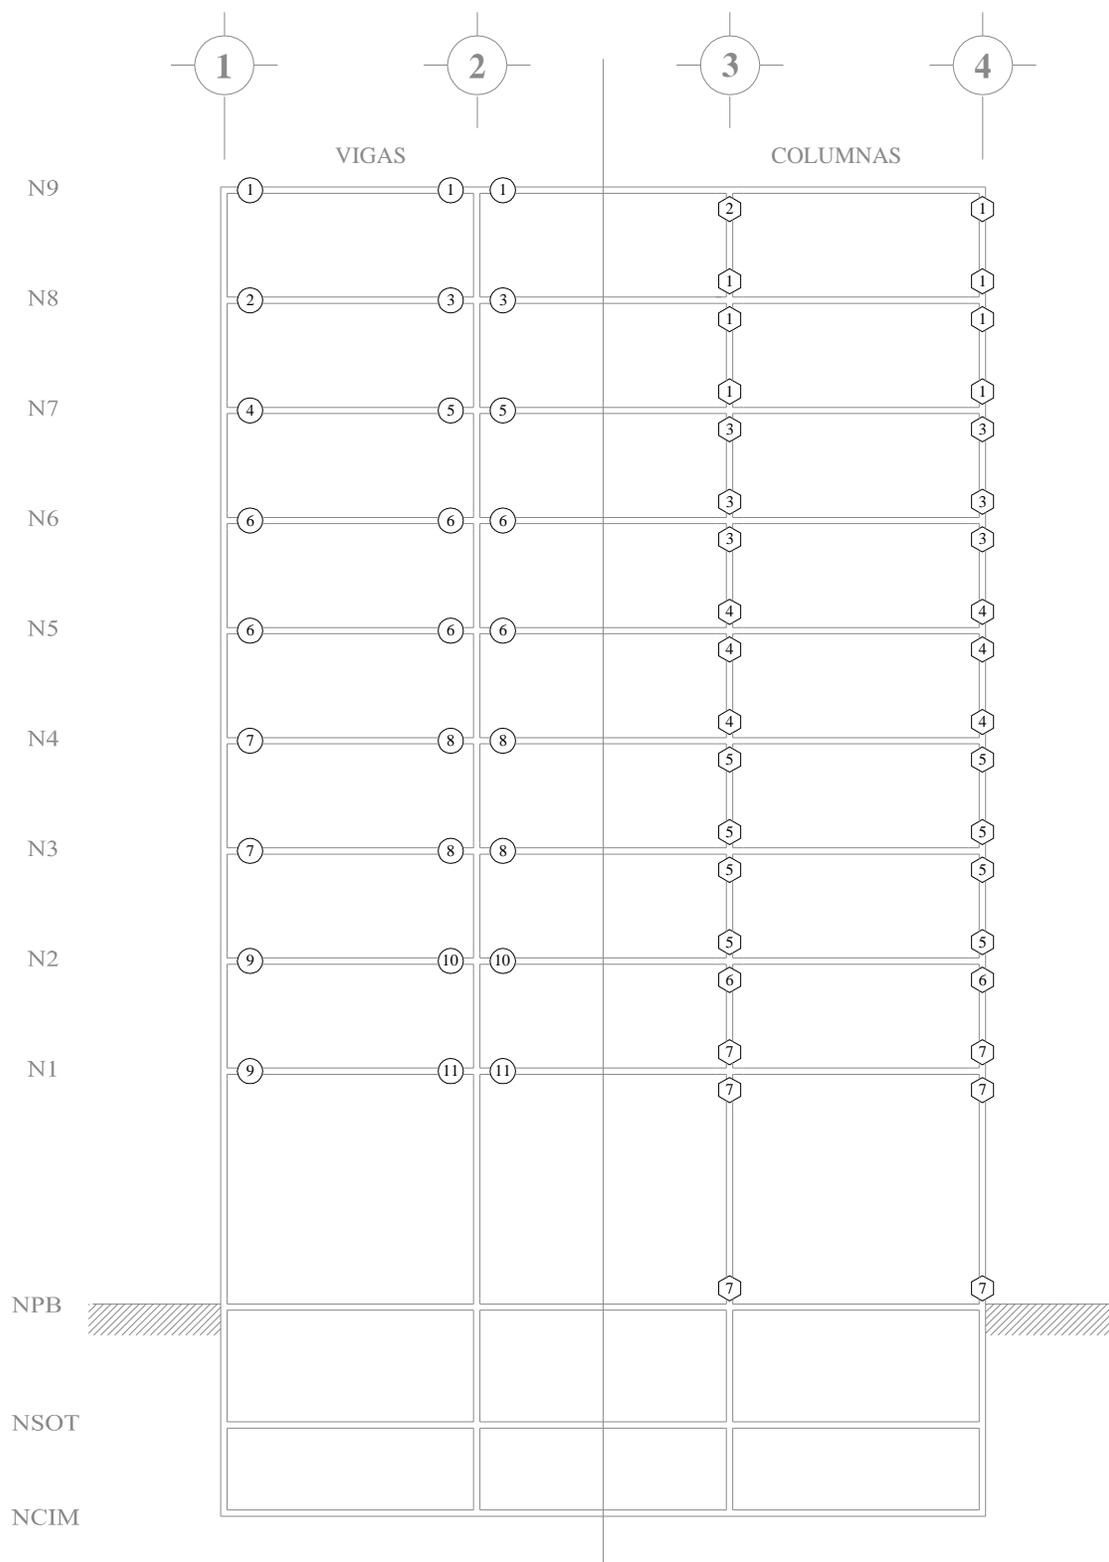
Ubicación de tipos de armados de vigas y columnas del eje C, edificio 9 niveles, Cuerpo Principal de las NTC-Sismo, RDF-04
